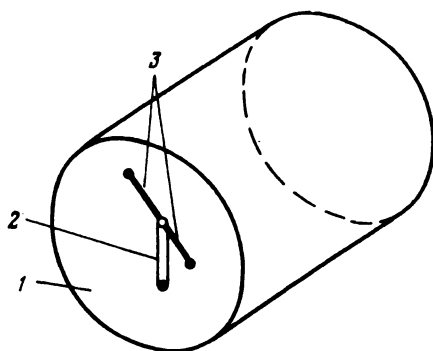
Схема установки прибора ШЦ-12 в полый цилиндрический элемент
